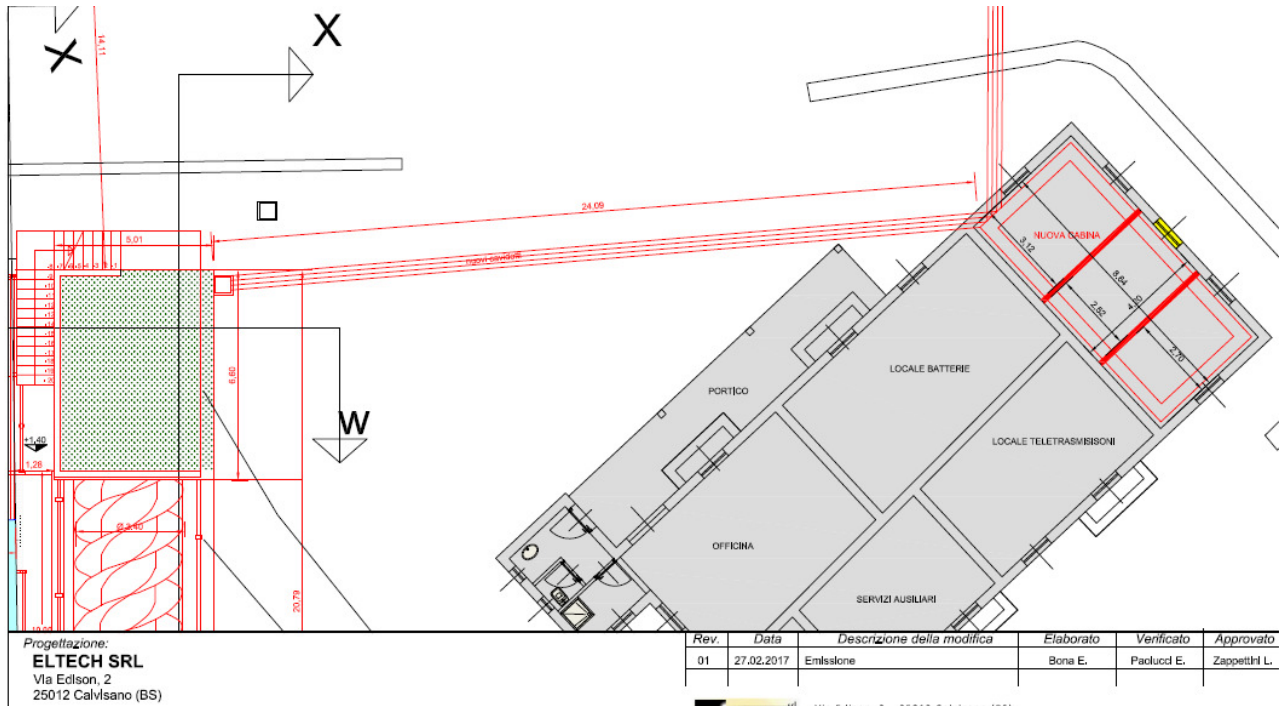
Planimetria pianta della nuova cabina con collegamento al nuovo impianto turbina
